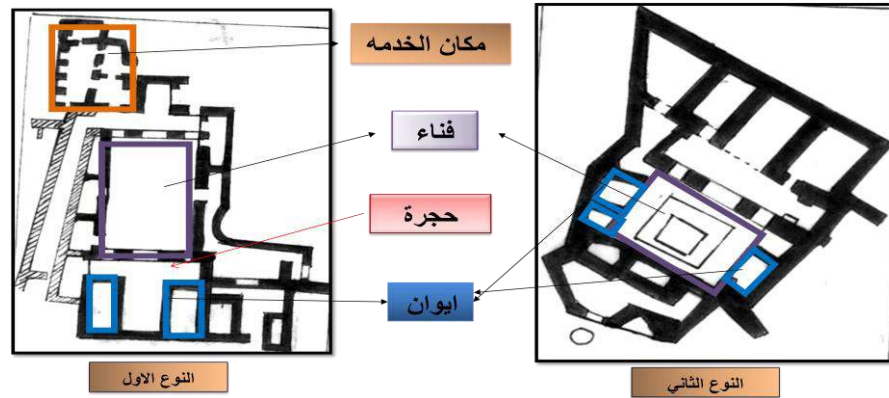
مسقط أفقي يوضح المسكن في العصر الطولوني^٢
